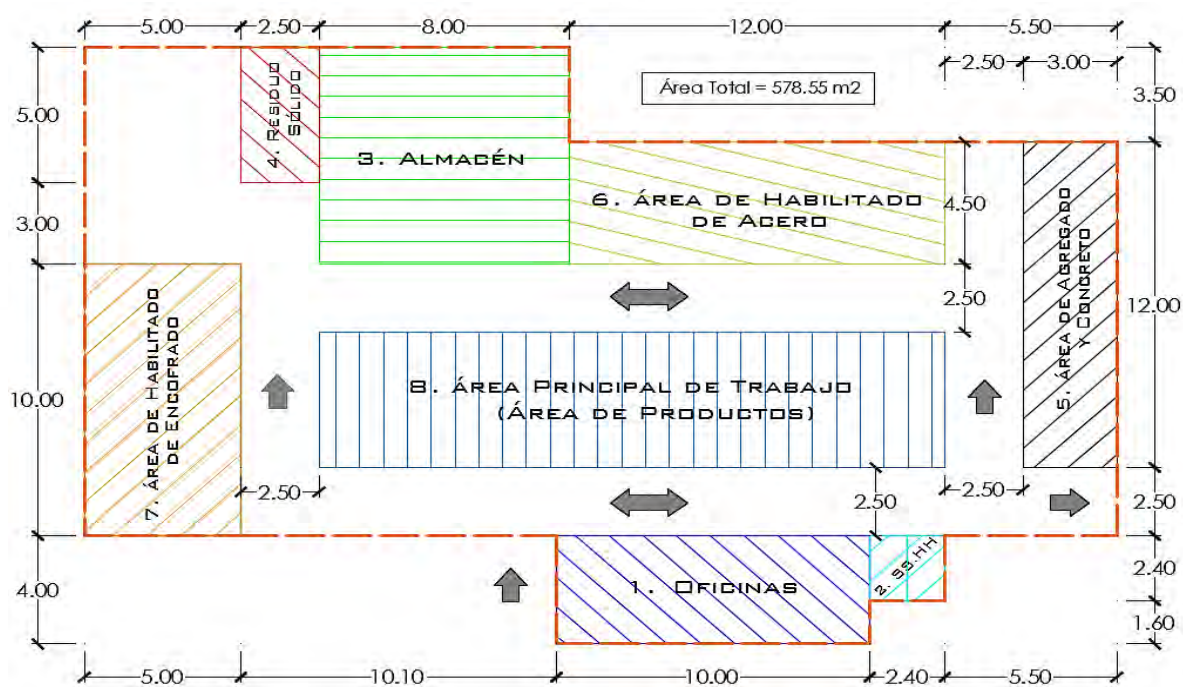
Disposición final de planta en obra para ejecución de la obra cimentaciones del nuevo edificio de personal obrero.
